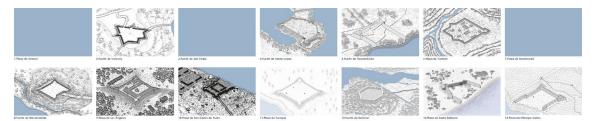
Modelos de trabajo en taller. Fuente: Taller de Proyectos y Construcción II (2023)
